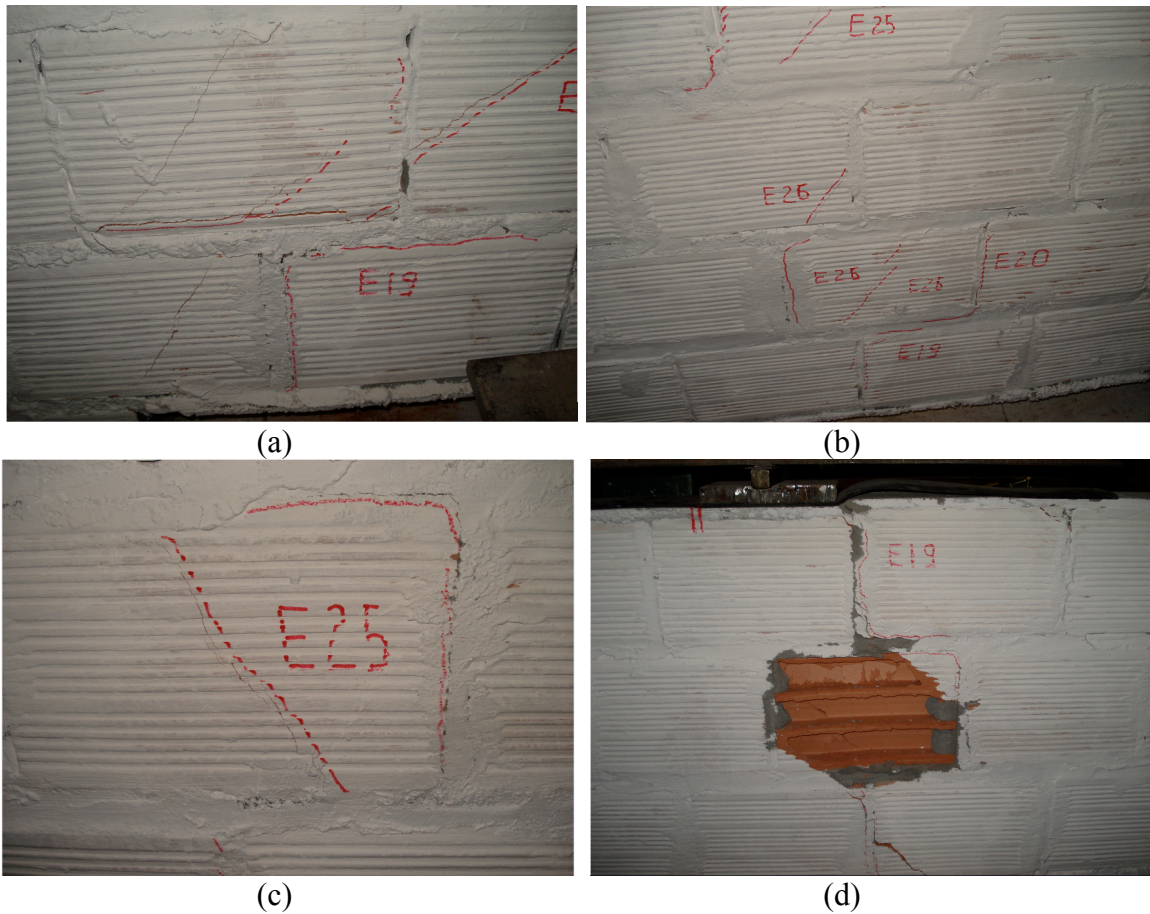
Detalhes das fissuras em cada etapa de aplicação da carga na mini-parede 2 da Série 3: (a) primeiras fissuras; (b) evolução das fissuras; (c) espessura das fissuras próxima à carga de ruptura; (d) rebaixamento e ruptura dos blocos após recarga.
